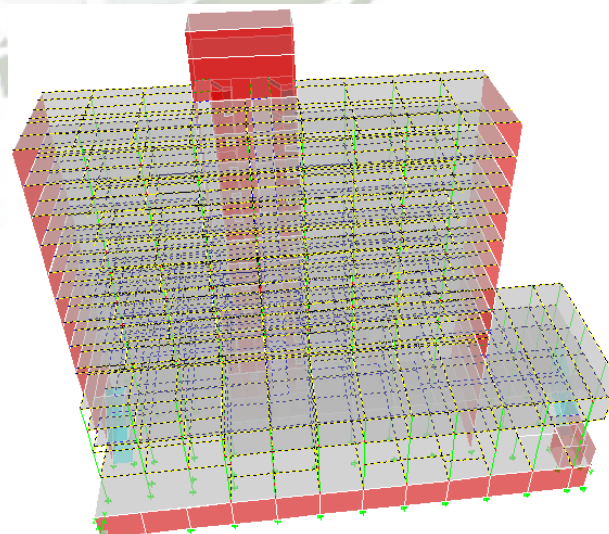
VIGAS SELECCIONADAS EN MODELO
